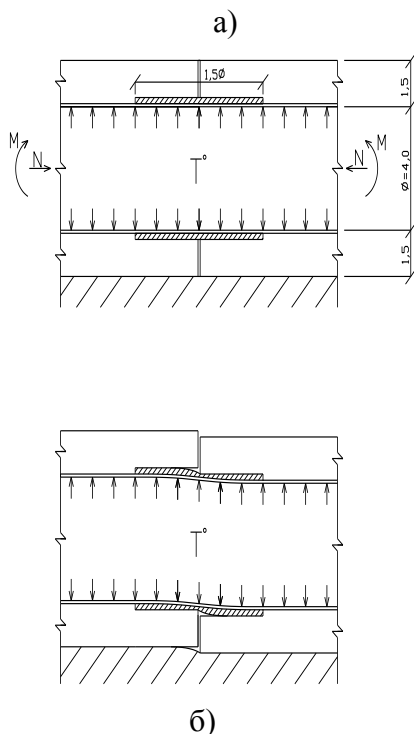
Расчетные схемы компенсационных участков сталежелезобетонных напорных водоводов с применением низко модульной прокладки:
